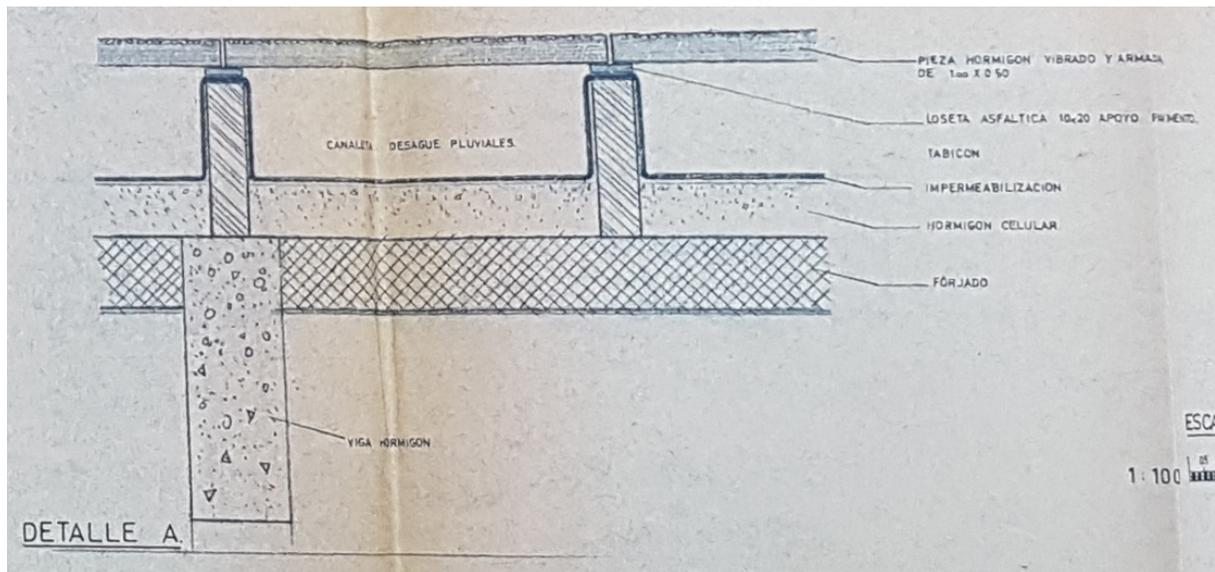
Detalle constructivo del pavimento original 1964. Fuente: Archivo Municipal da Coruña
